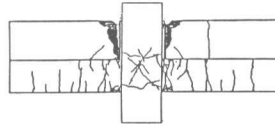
No.5(円形空洞目地) 最終ひび割れ状況
